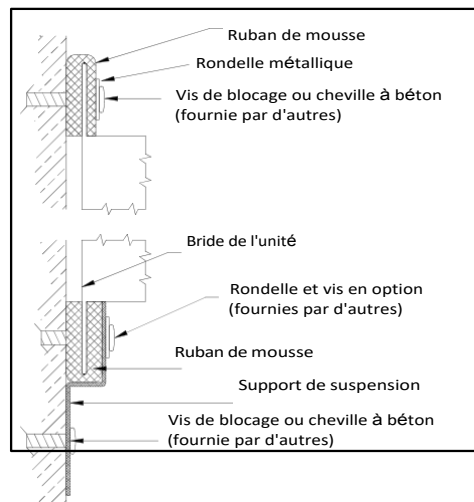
MONTAGE DE L'ERV SUR UN MUR D'OSSATURE
